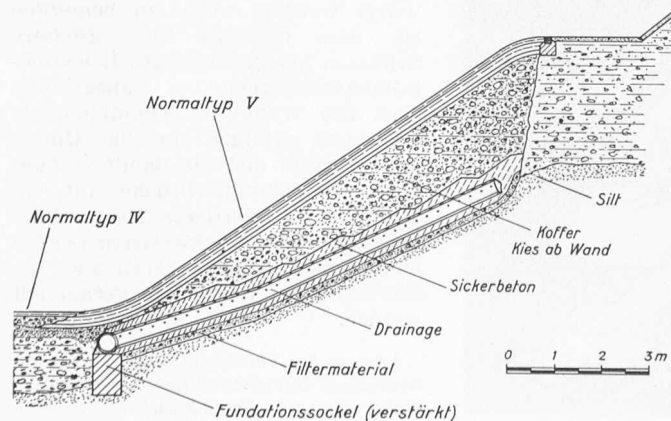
Siltrutschung; Drainierung, Konsolidierung und Unterbau für die Belagsschichten, Querprofil 1:160
